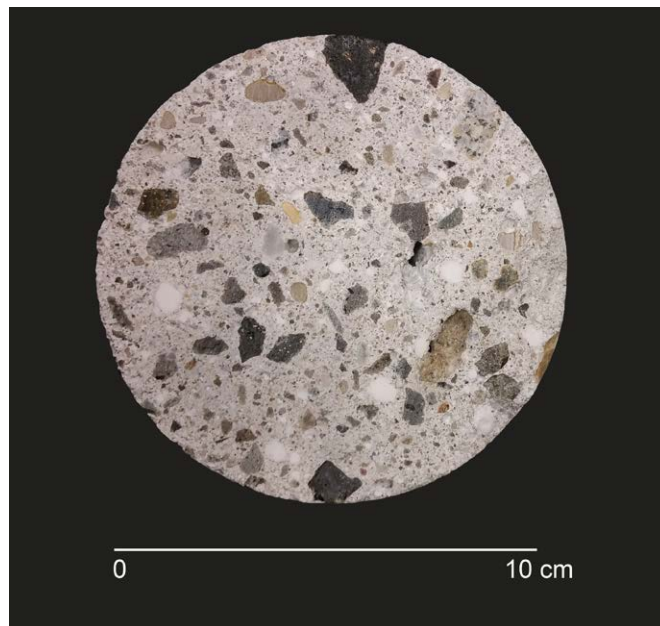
Padova, teatro. Campione di opera cementizia prelevato dalle fondazioni dell'edificio. / Padua, theater. Sample of concrete taken from the building foundations.
